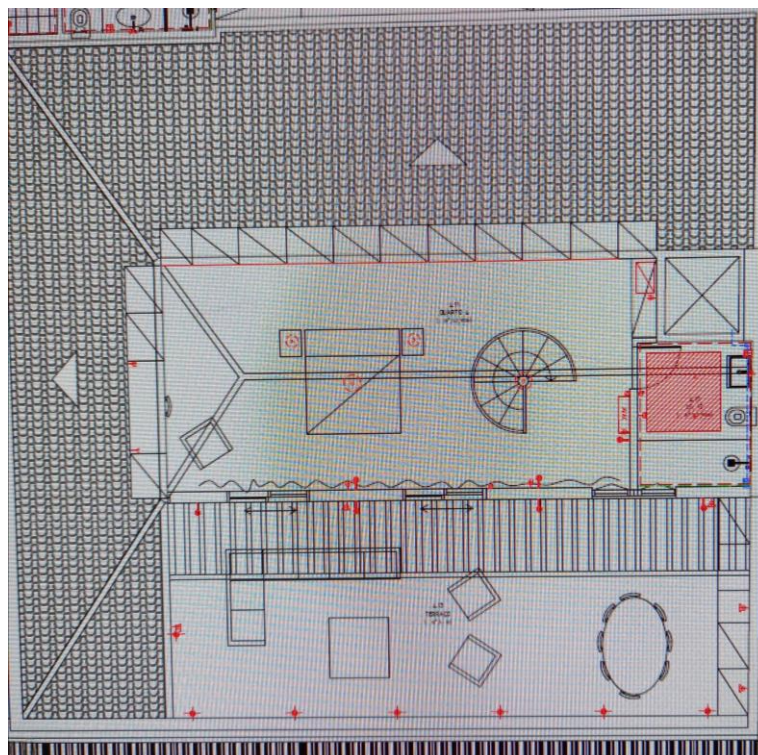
Planta de eletricidade da zona do sótão. Fonte: Atelier Studio Arte
